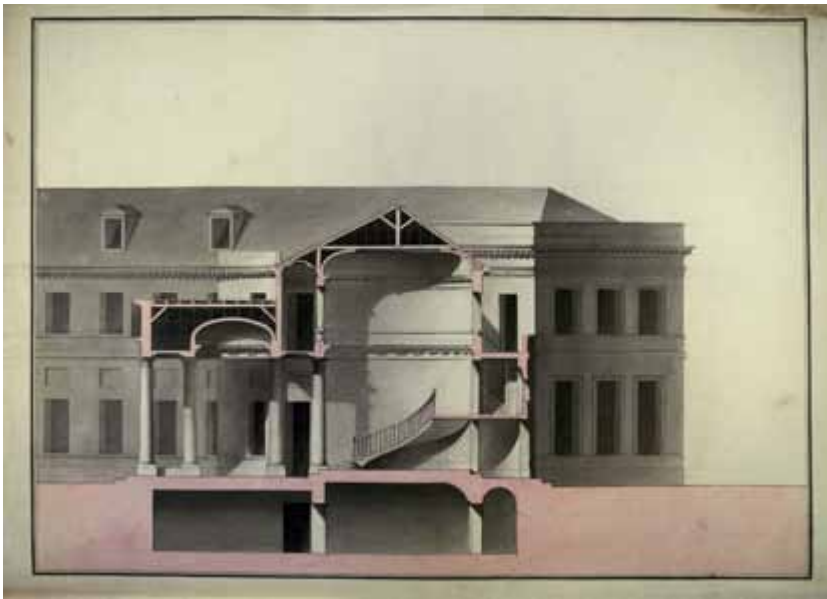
Projet de château d'Enghien à la Cense, coupe sur l'entrée et la cage d'escalier (Archives Générales du Royaume).
